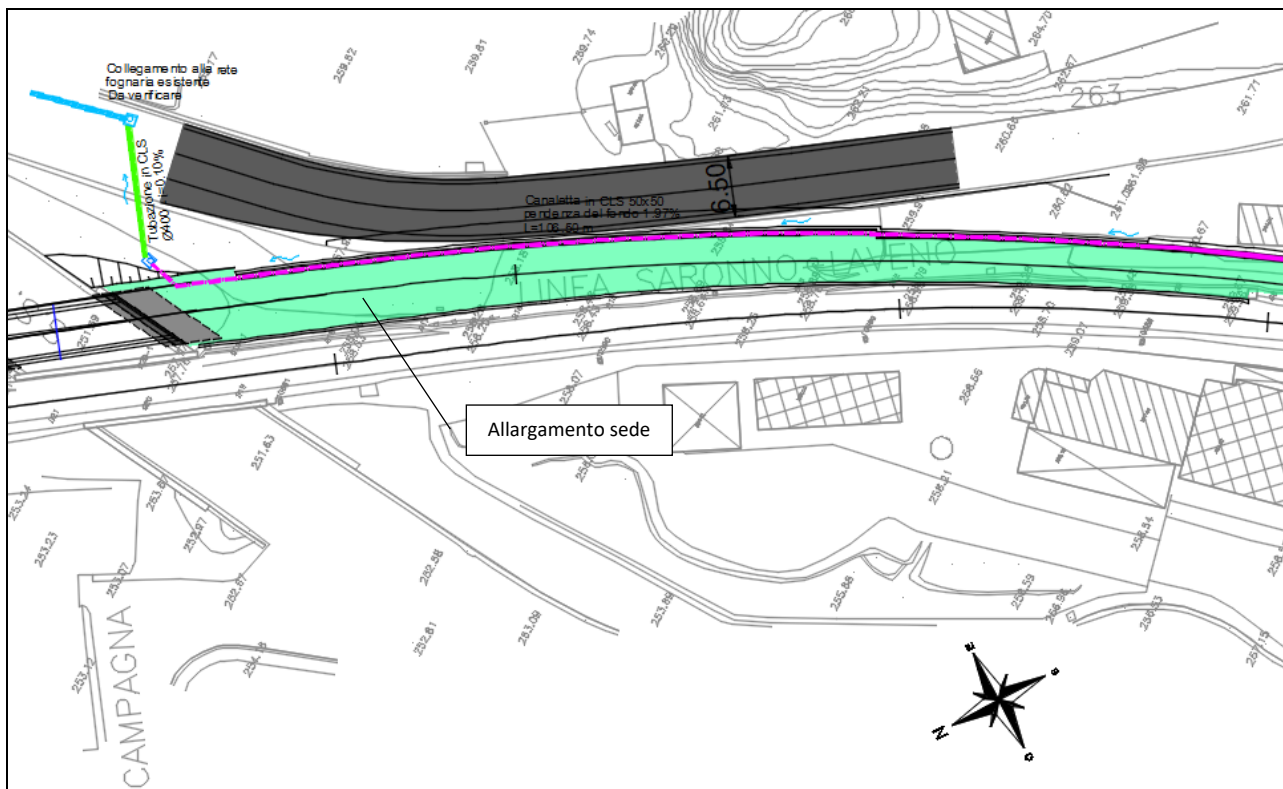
Stralcio planimetrico delle sistemazioni idrauliche in prossimità di via Battisti
